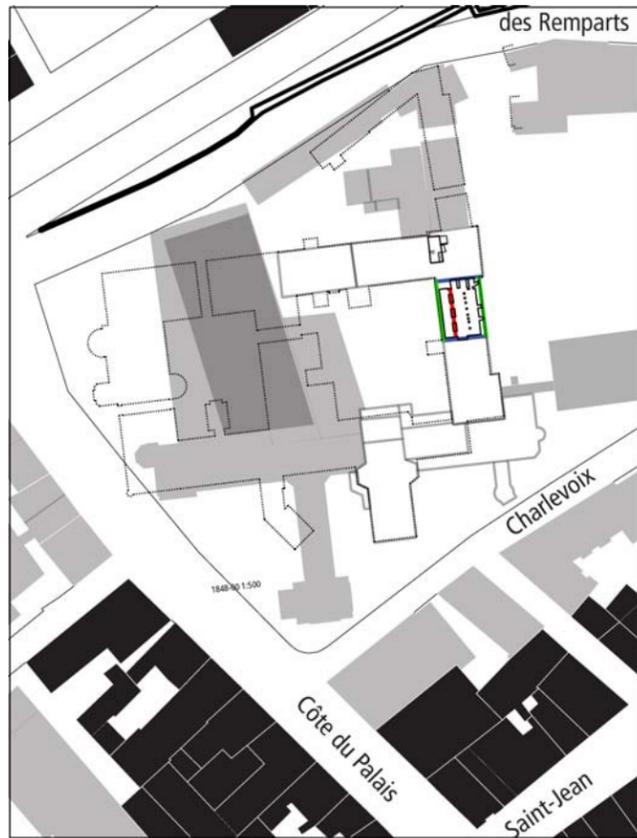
Composition structurale des murs porteurs, 1910, étage des fondations (niveau 00)
